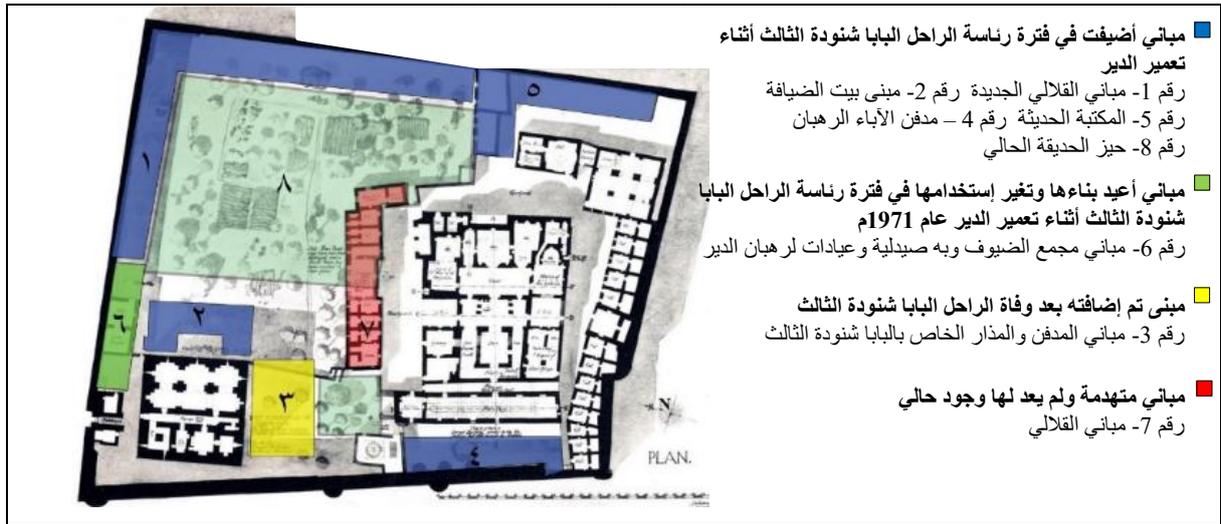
مسقط للدير الأصلي دير الأنبا بيشوي
